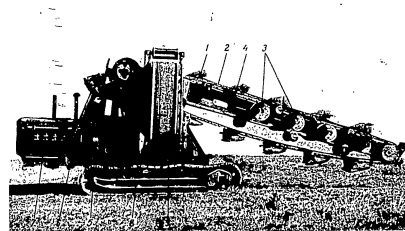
Основные узлы экскаватора модели ЭТУ-353: 1 — ковш; 2 — ковшовой цепь; 3 — шнековый уширитель; 4 — ковшовой раме; 5 — механизм подъема рабочего органа; 6 — рама экскаватора; 7 — силовая установка; 8 — гусеничный ход; 9 — ленточный транспортер
